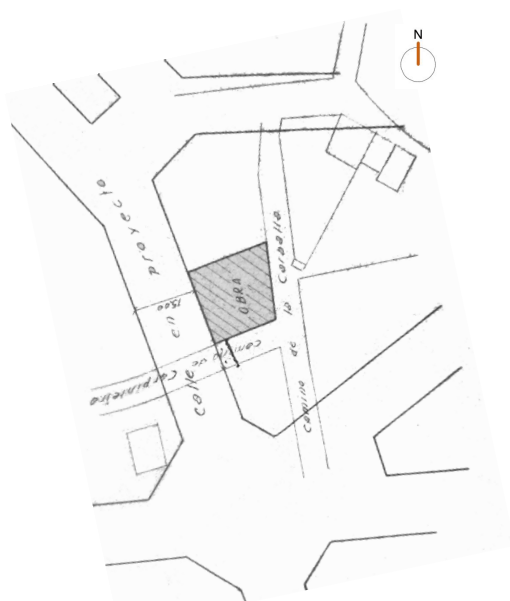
Plano de situación original, en planta, del edificio ubicado en la Rúa Eugenio Kraff, nº11. La flecha indica la fachada frontal, por la que se accede a las viviendas (fotografía de autoría propia).
